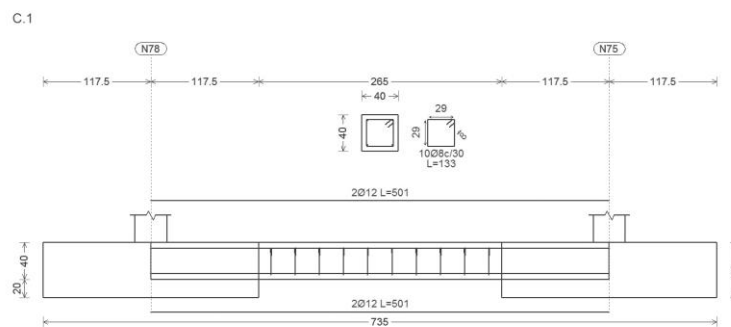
Esquema de las dimensiones de la viga de atado
